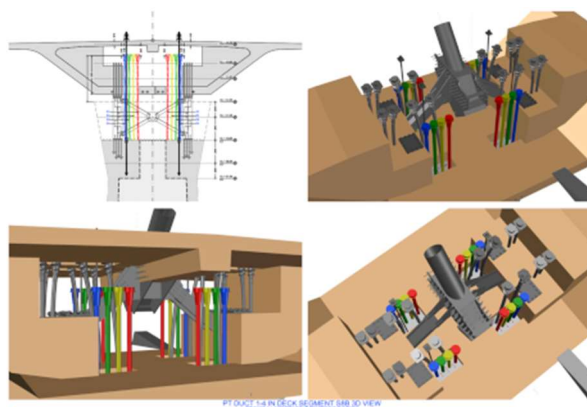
Familias de postesado en pilas anclaje S2 y S3.
